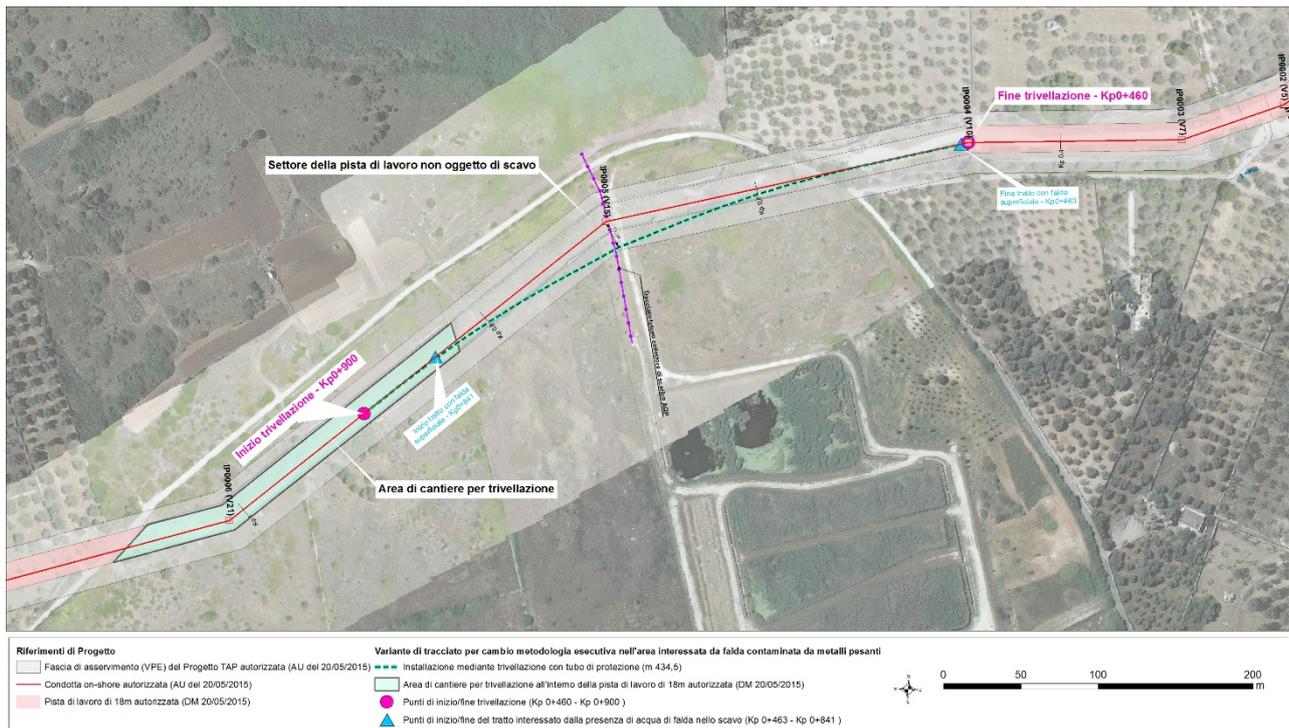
Inquadramento planimetrico delle aree di lavoro
